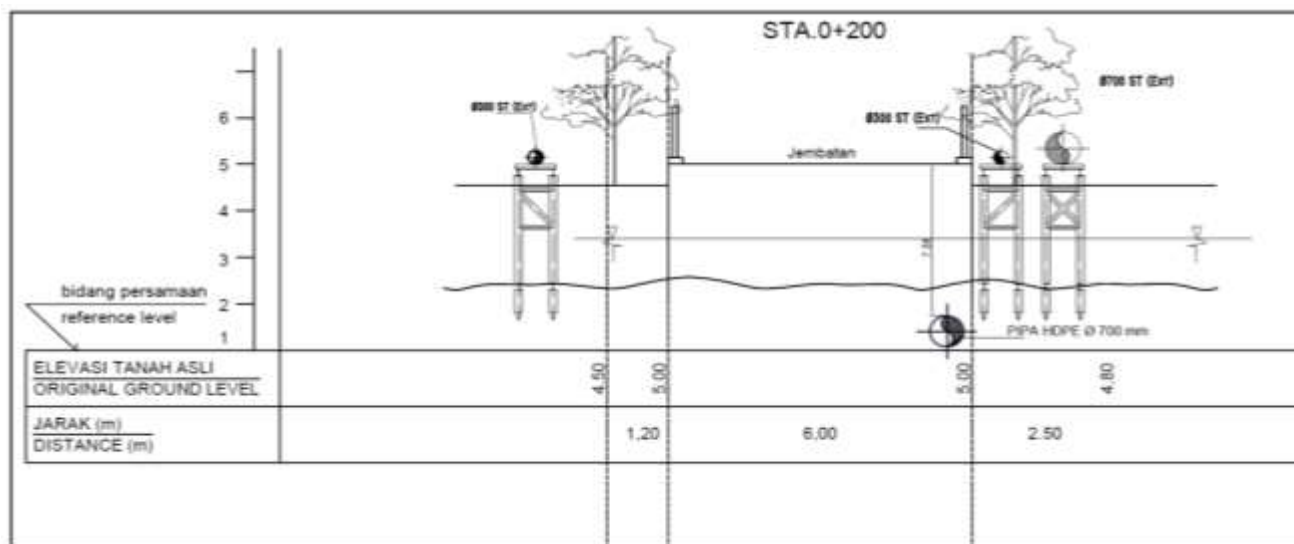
Layout Jalur Pemasangan Pipa Diameter 700 mm
